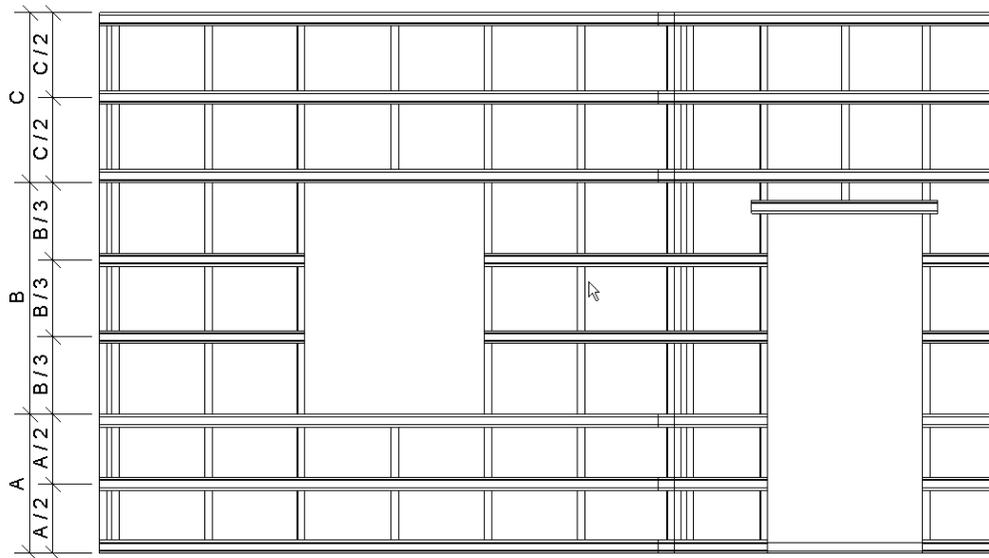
Монтаж наружной стеновой вентилируемой обрешетки.
